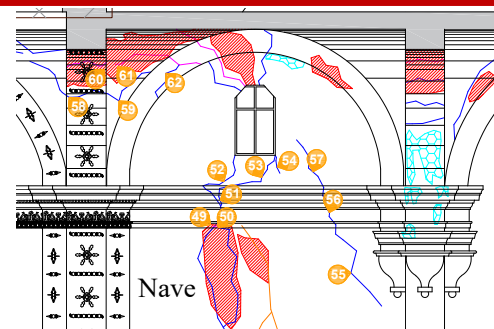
Detalle de afectaciones presentes en juego de molduras en muro interior sur
